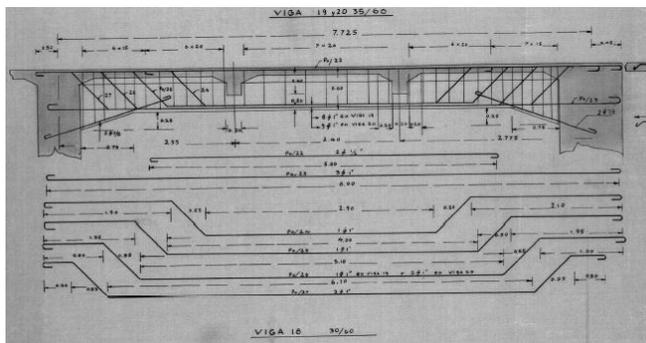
Detalle sistema Ways en vigas Palacio de Tribunales. Fuente: Archivo DEPA MOP
